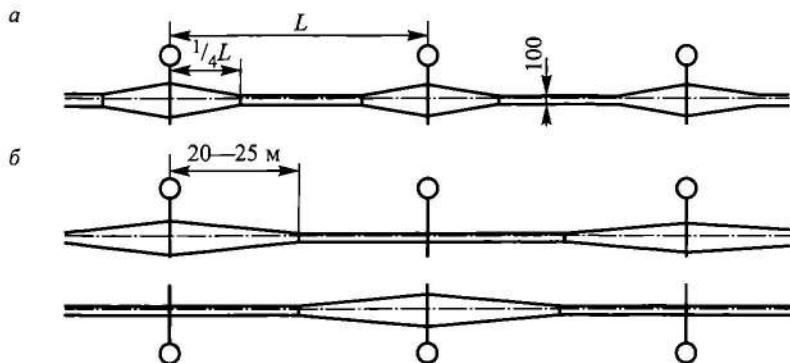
Схемы расположения в плане контактных проводов ромбовидных подвесок
